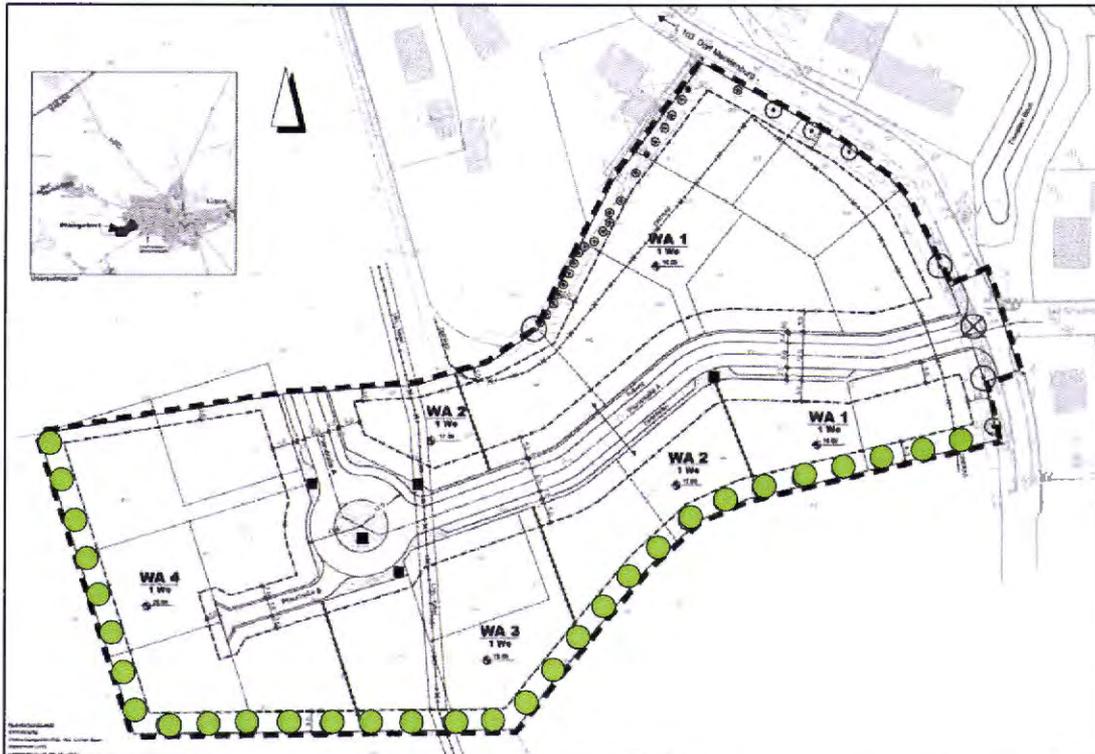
Festsetzung der Obstbaumpflanzungen laut B-Plan. Lage der Obstbaumneupflanzung grün hervorgehoben.
